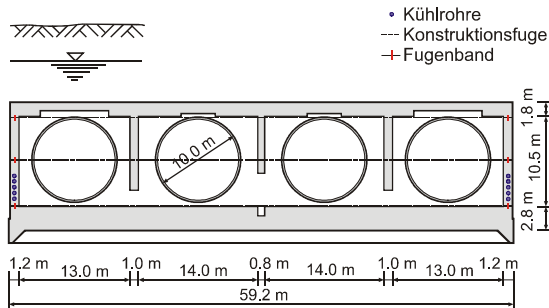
Tunnelquerschnitt (Senkkasten)
